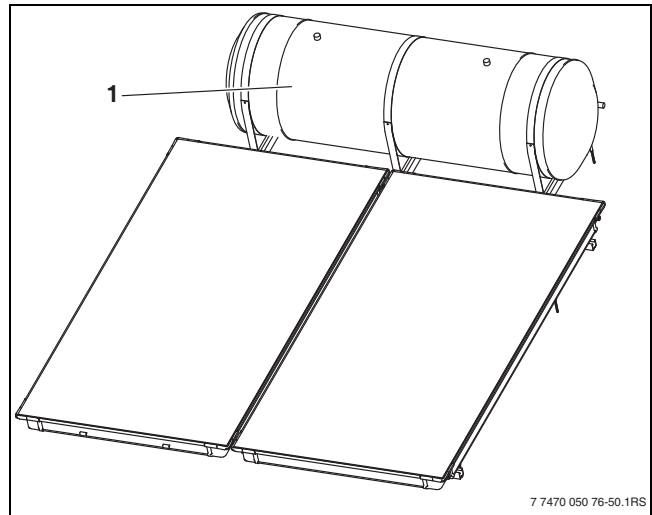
Vista montaje en tejado inclinado (sistema de 300 l)
